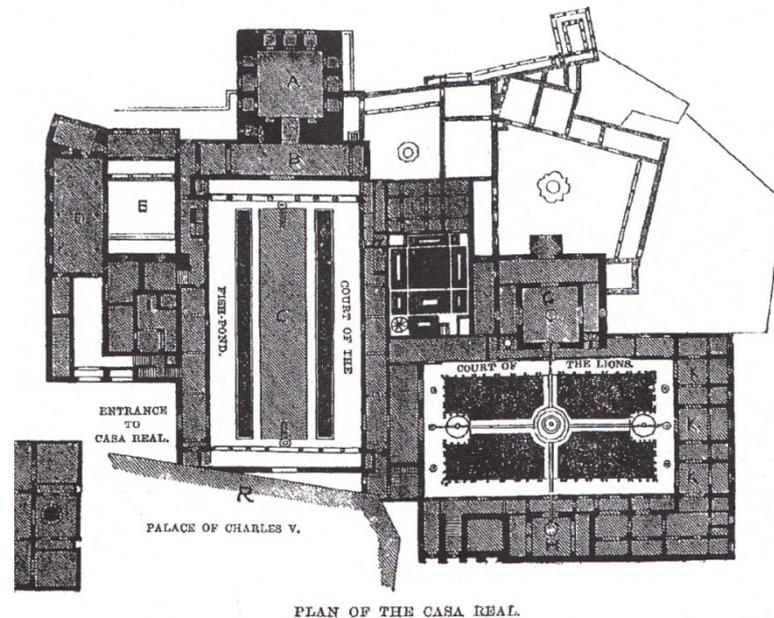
planta do palácio Alhambra. (Jones 1911)
